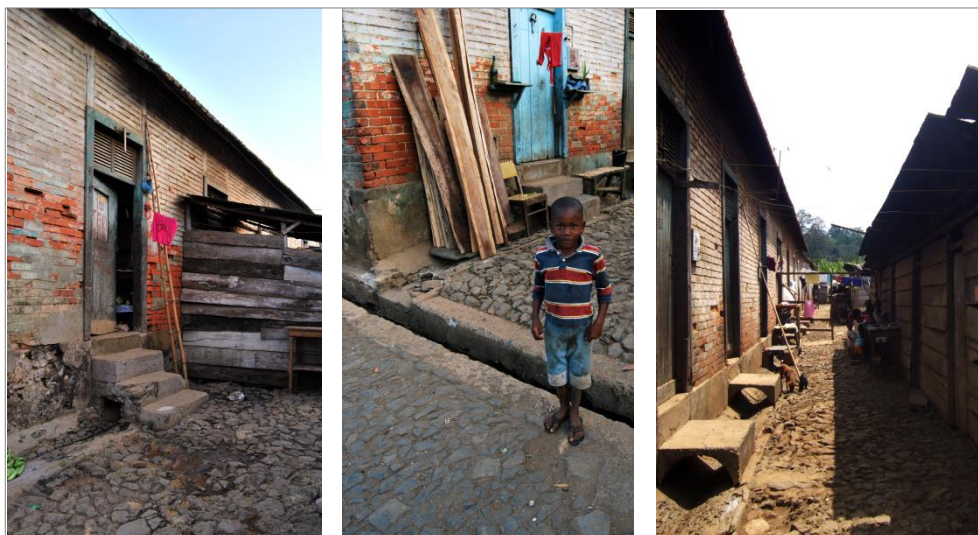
| PORMENORES CONSTRUTIVOS - ESCOAMENTO DAS ÁGUAS – USOS E OCUPAÇÕES – 2014 / 2010
